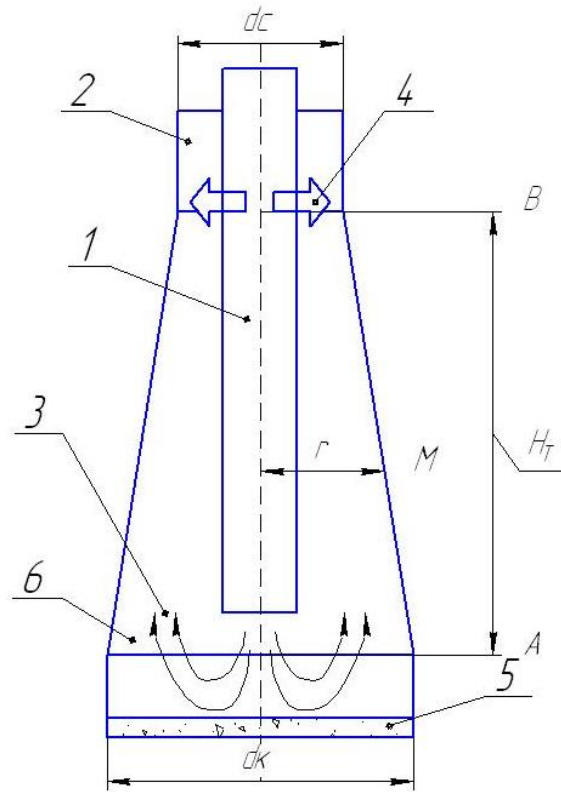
Схема розташування терморозширювача у свердловині
